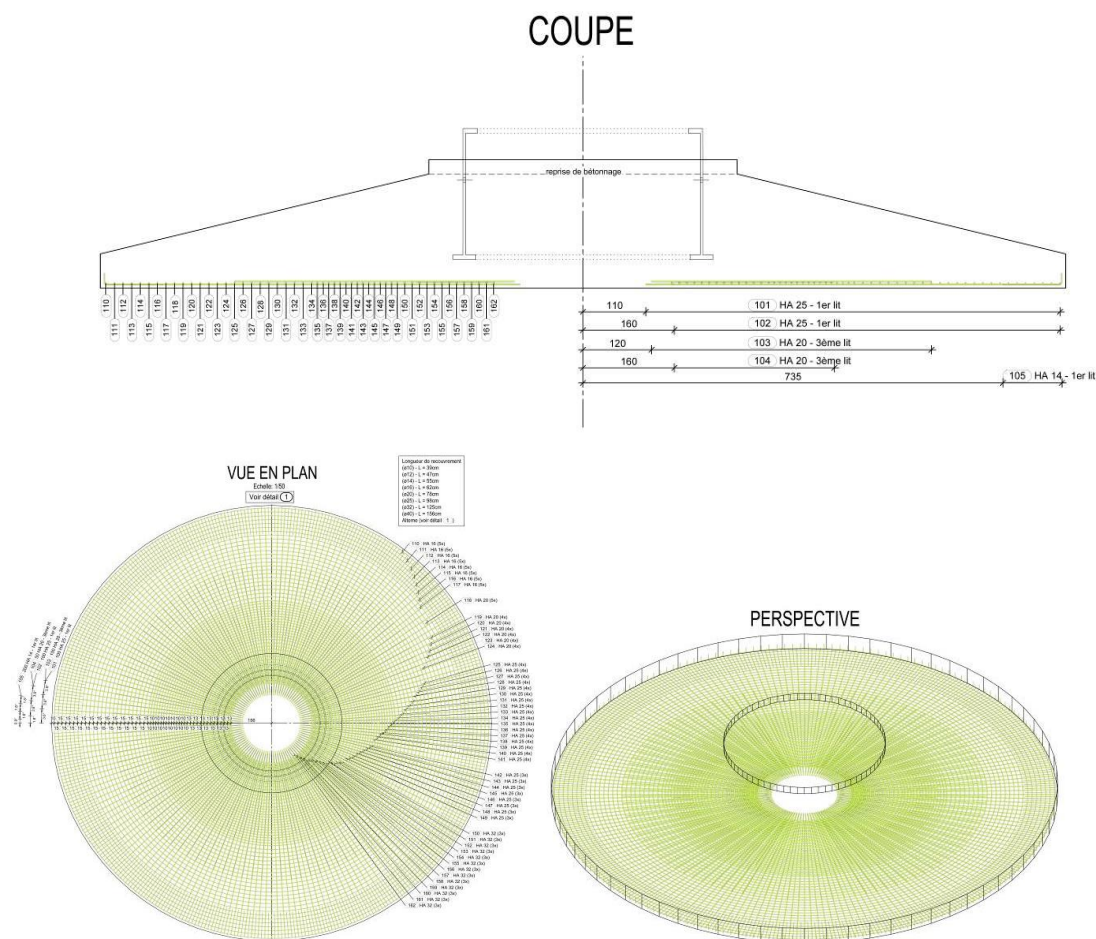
Coupe d'une fondation d'éolienne - Source : Vestas
